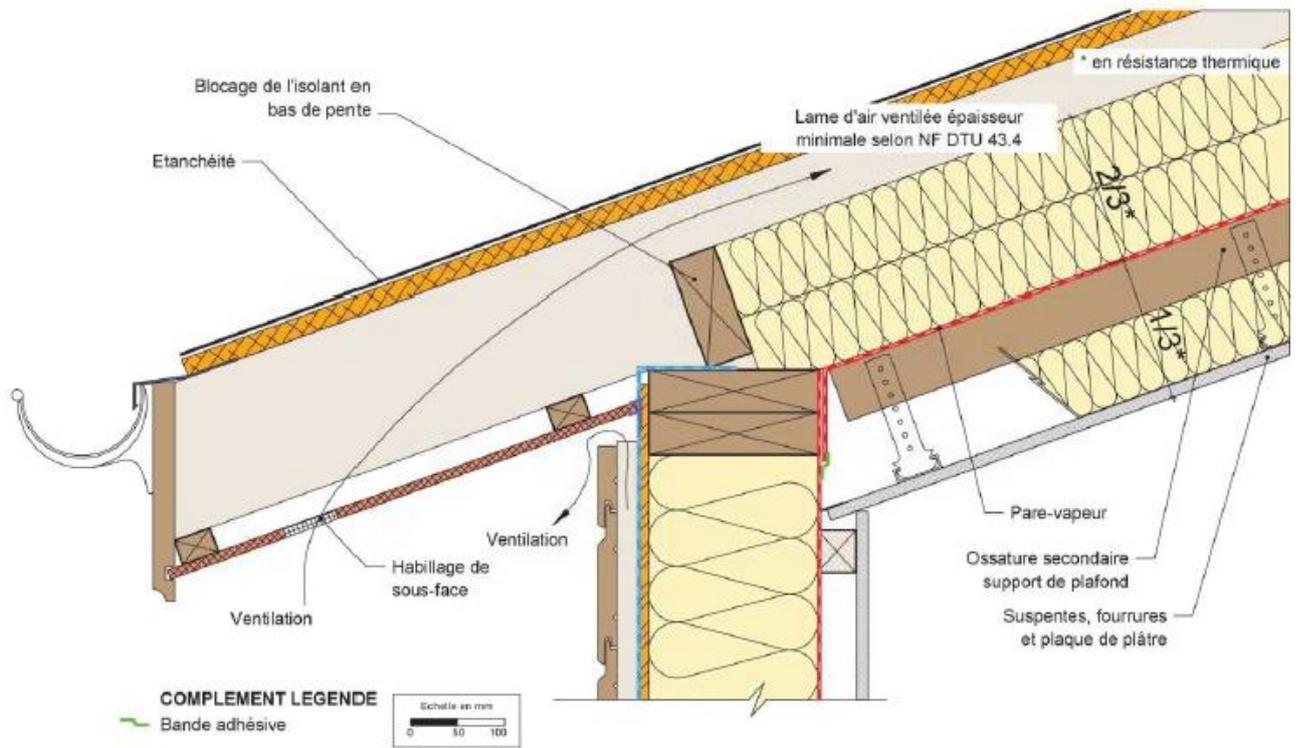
Exemple de ventilation en sous-face de l'élément porteur de l'étanchéité (coupe verticale)
